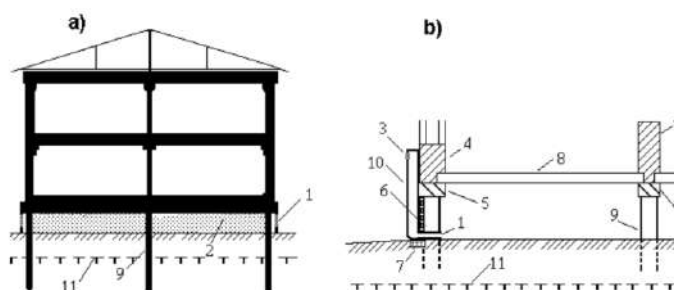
Схемы здания с вентилируемым подпольем (а) и (б) – фрагменты подполья, 1 – вентиляционные отверстия; 2 – вентилируемое подполье; 3 – решётка; 4 – стена здания; 5 – рандбалка; 6 – ограждение цоколя; 7 – вспомогательная (цокольная) балка; 8 – перекрытие над подпольем; 9 – свая; 10 – приставной вентиляционный короб; 11 – верхняя граница многолетнемёрзлого грунта [1]
